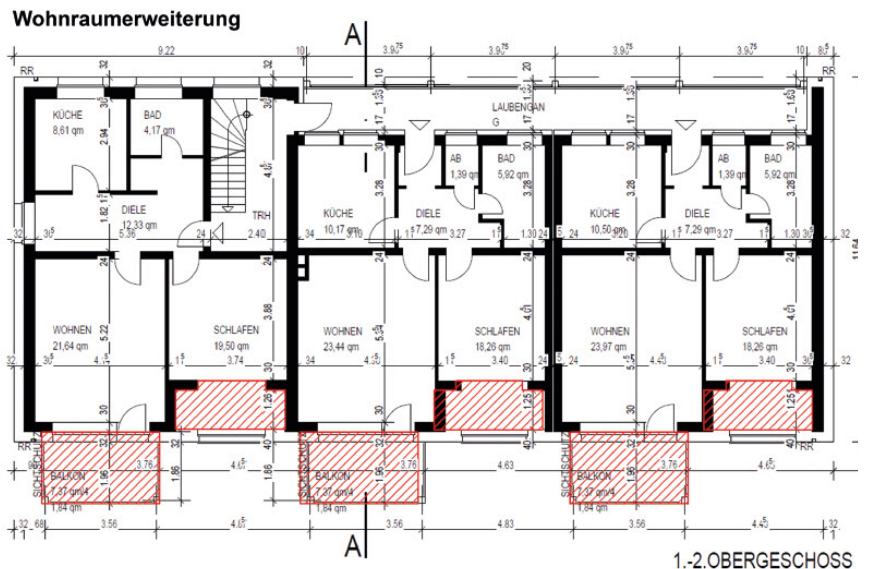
Der Grundriss zeigt die Erweiterung des Wohnraumes durch die Sanierung.
